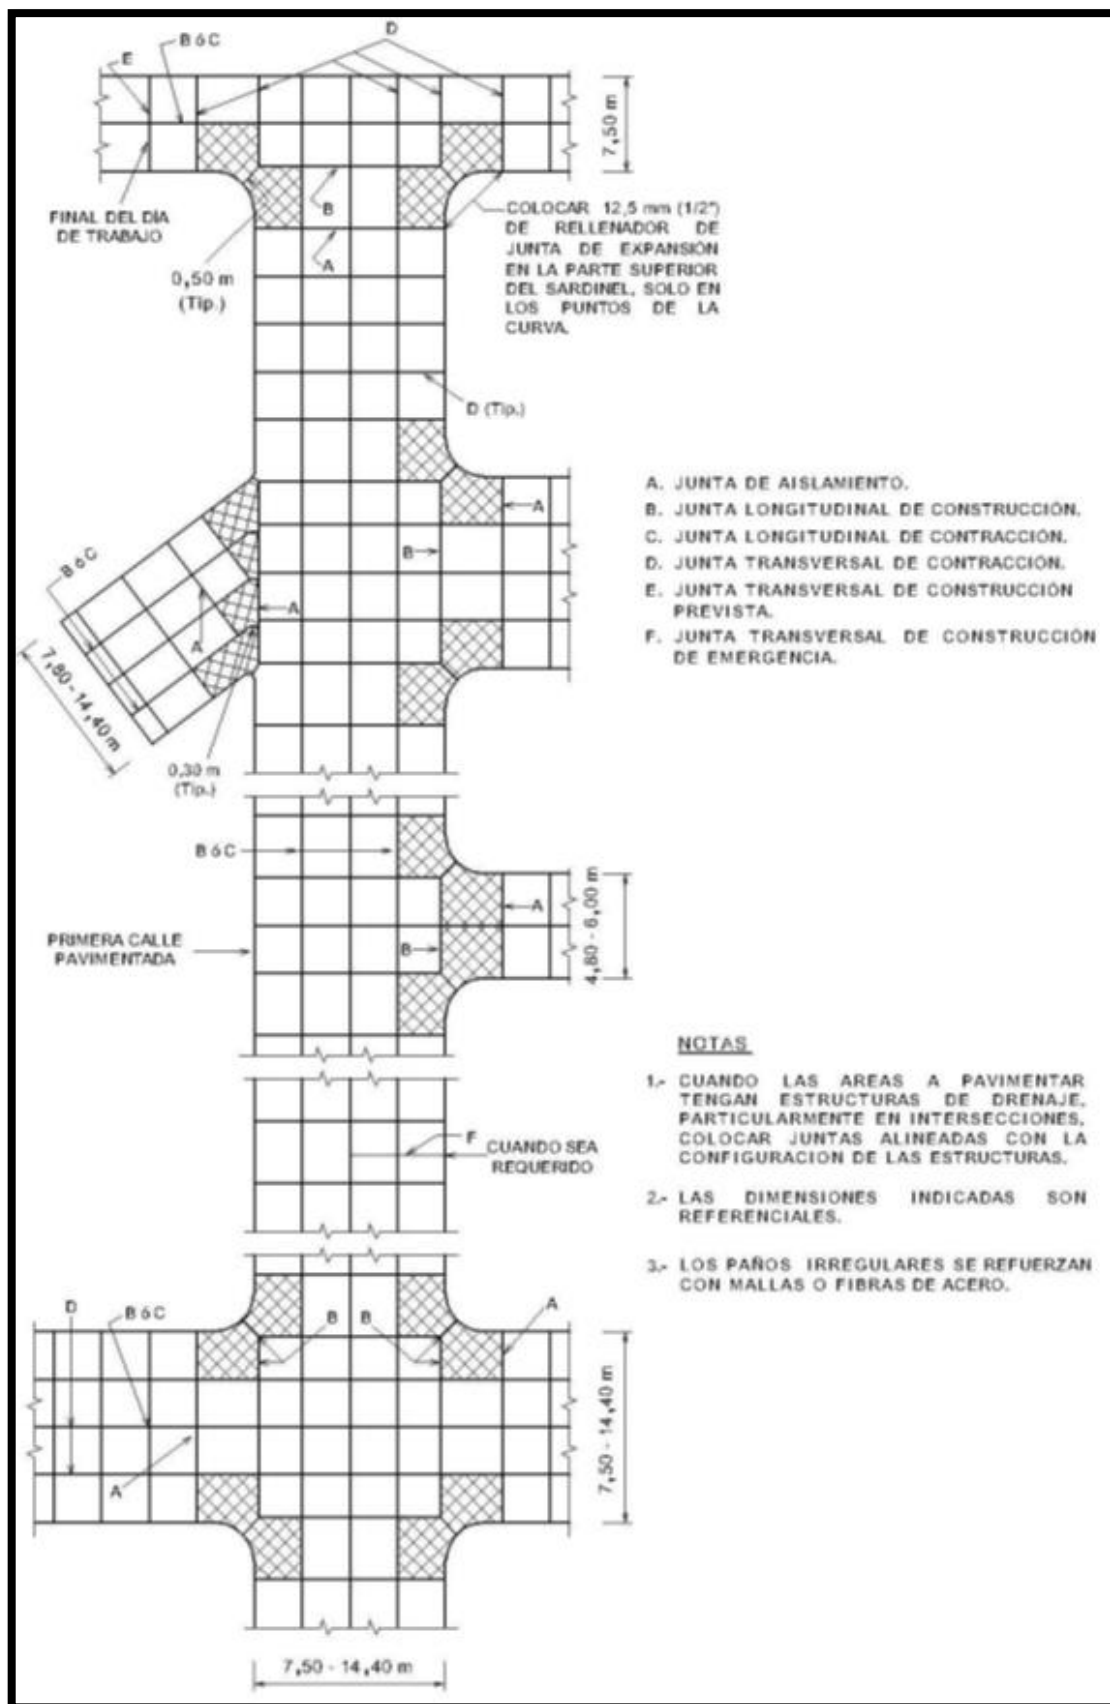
, Ejemplo de distribución de juntas en pavimentos de concreto hidráulico.
